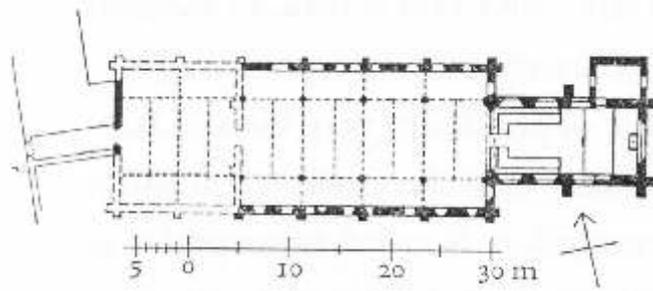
Planta esquemática do Hospital St. Mary, organizado em três naves. Fonte: LEISTIKOW,1967.
